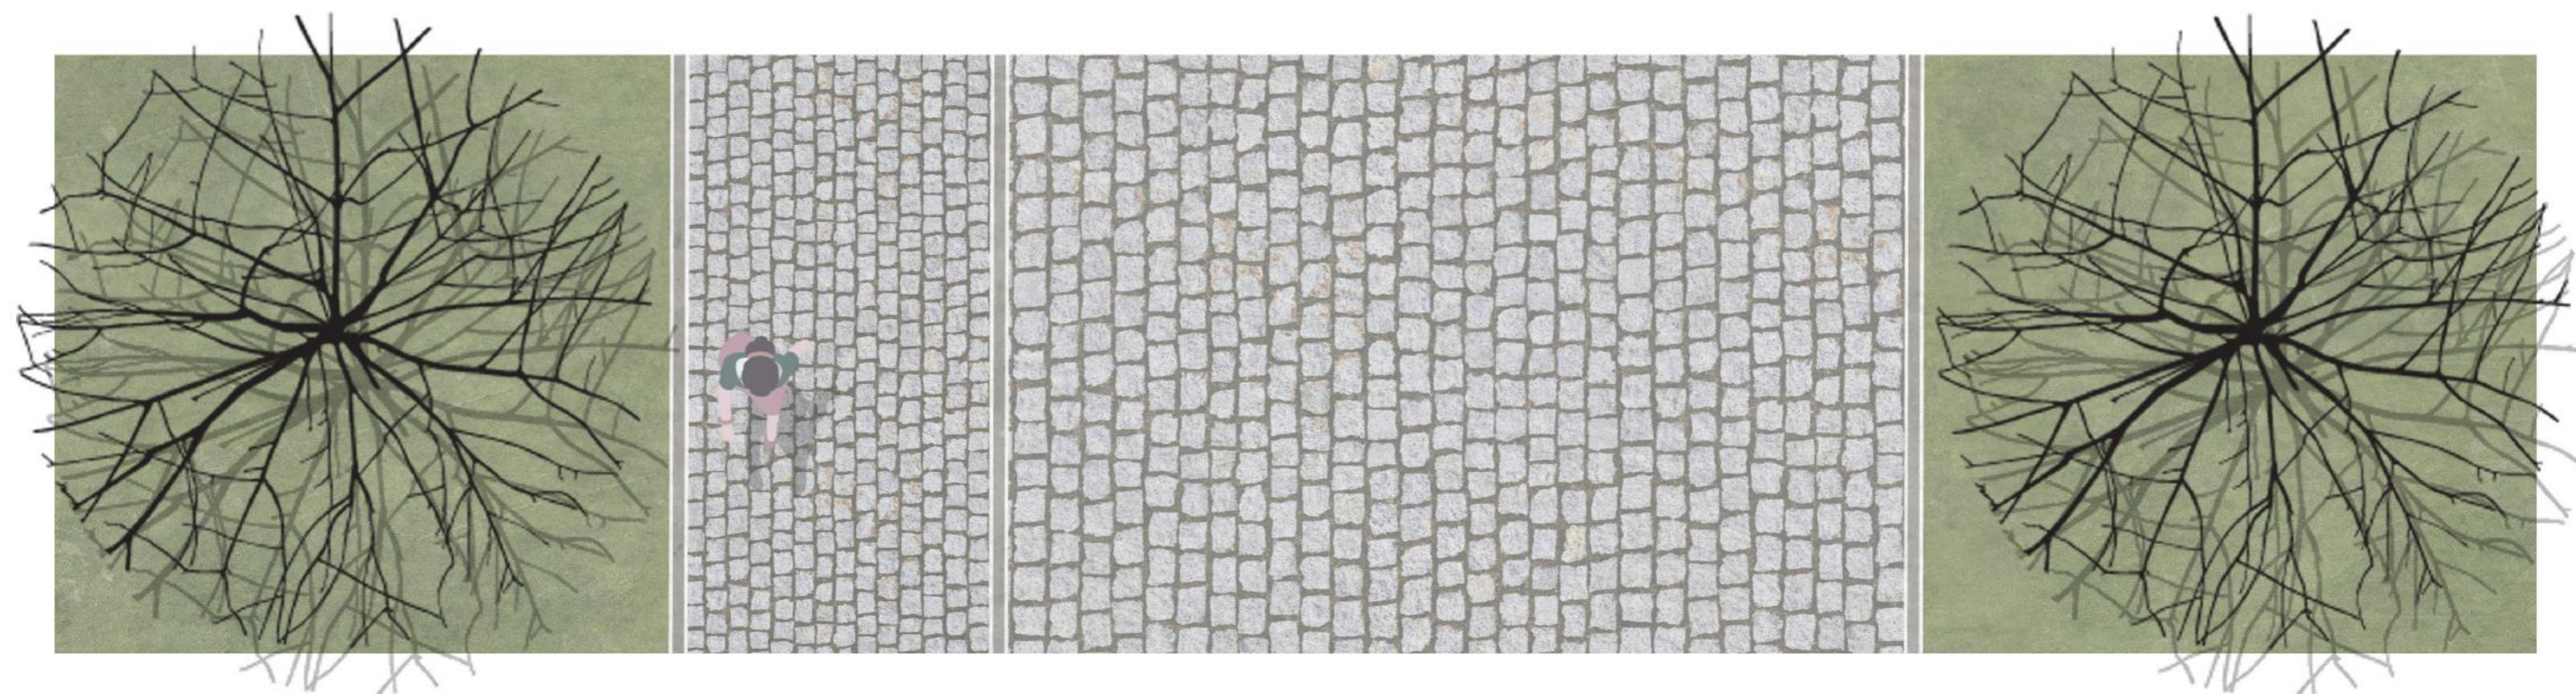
Technický detail, řez kamennou cestou v sadu (autorka 2024).
